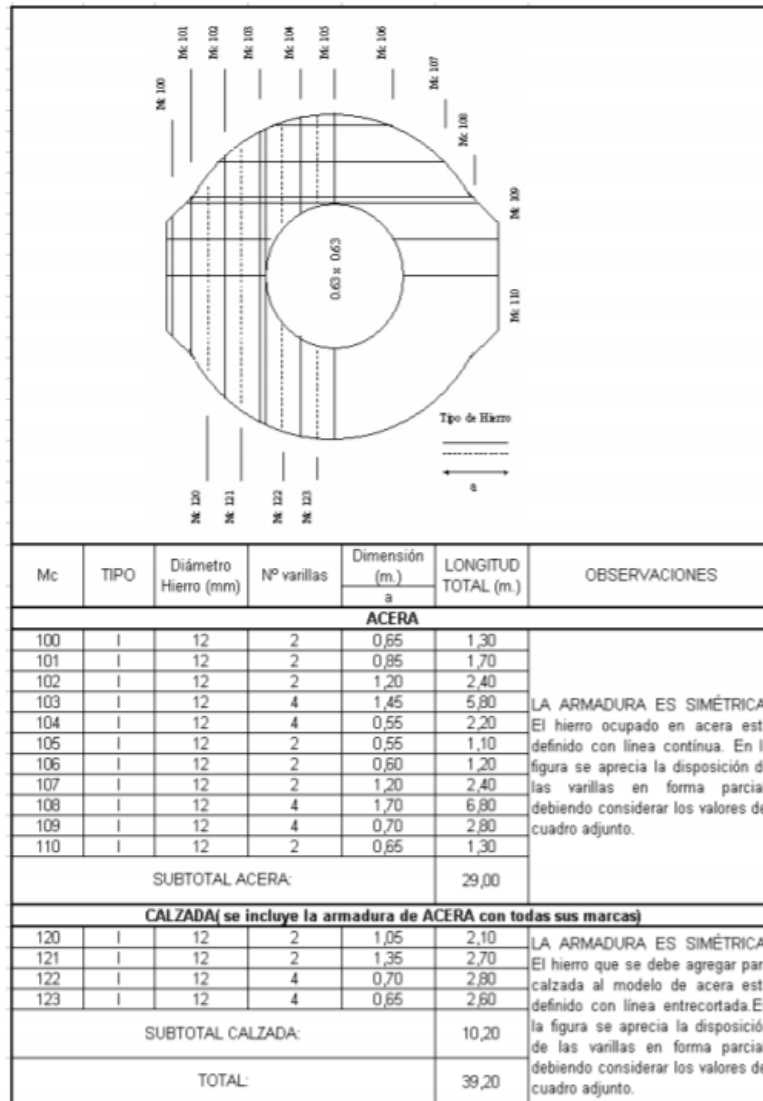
Armadura del Pozo de Revisión de 48 Bloques
